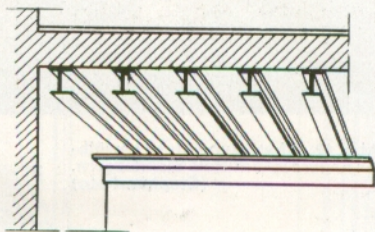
Absteifung einer ebenen Kellerdecke mittels Stahlträgern.
